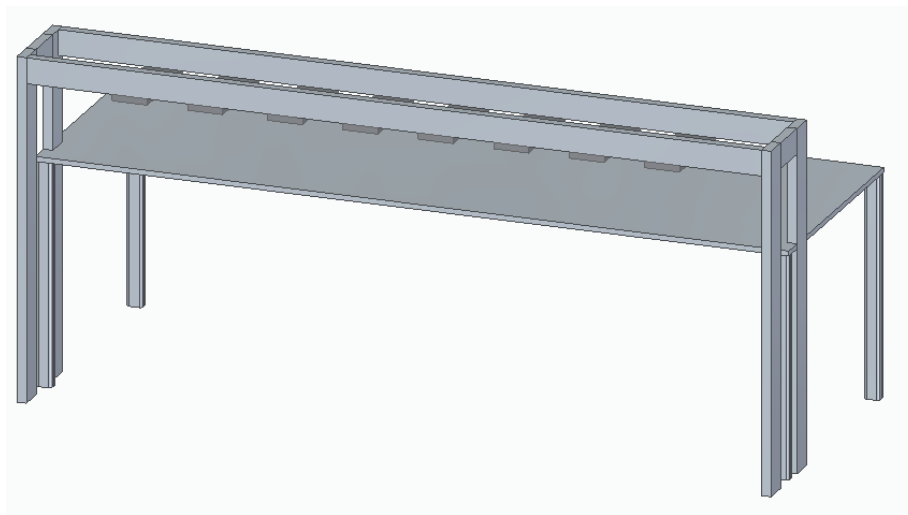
Instalación vigas horizontales y placa de soporte superior
